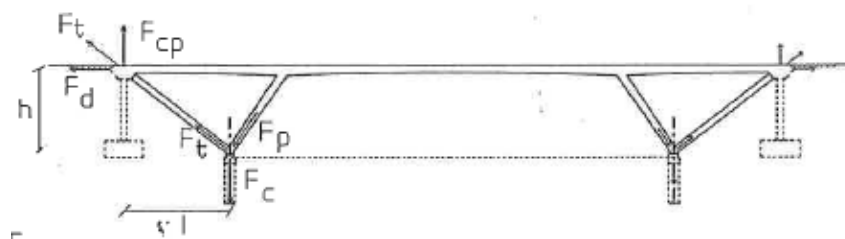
Pórtico con traslado de la reacción horizontal H a los estribos
